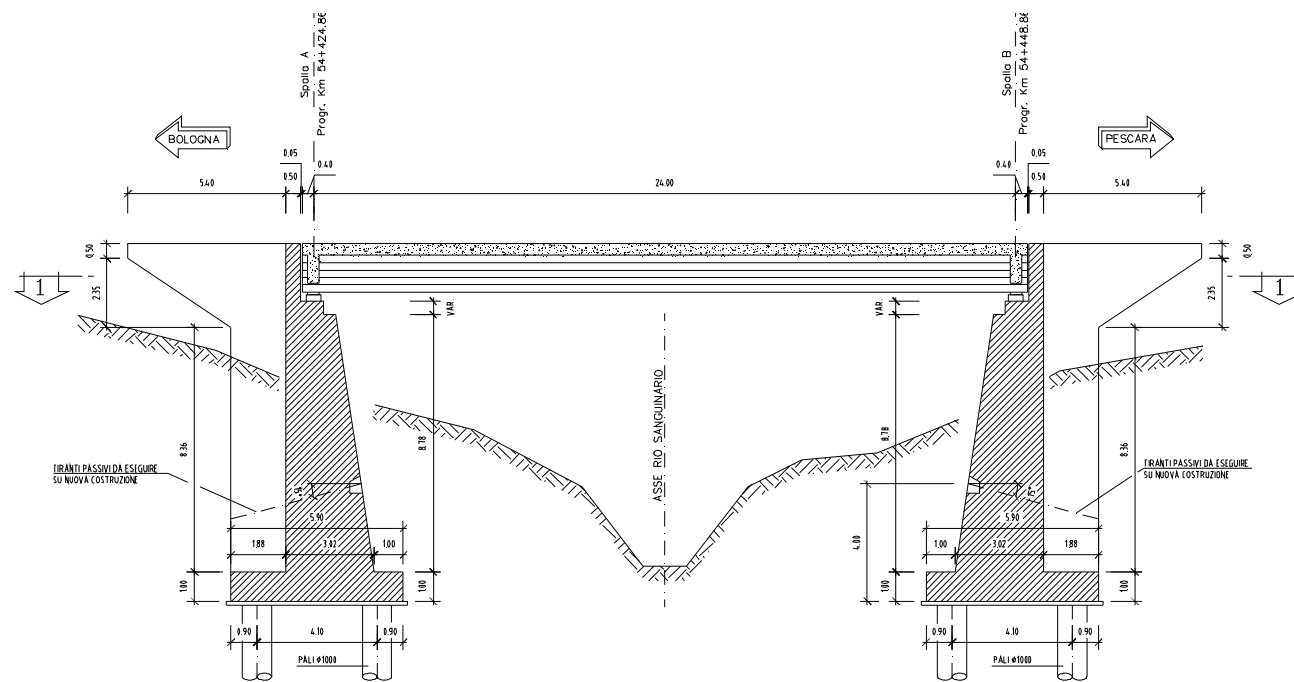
Ponte sul Rio Sanguinario - Sezione longitudinale su struttura ampliata
